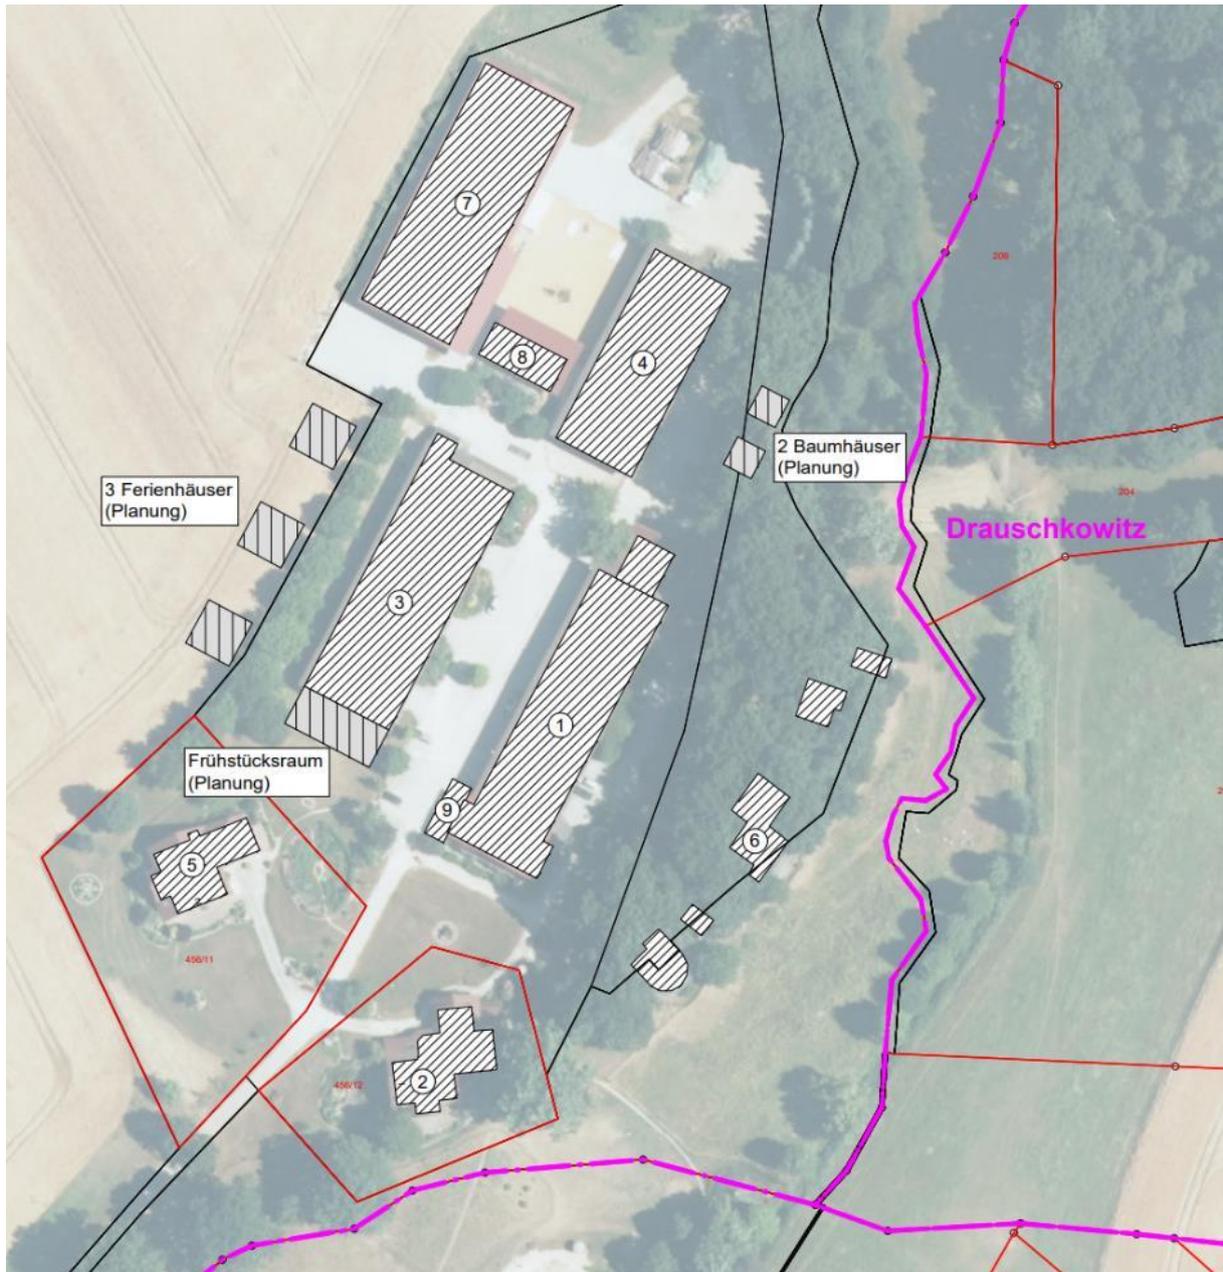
Lage des baulichen Bestandes entsprechend der erteilten Baugenehmigungen (tatsächlichen Nutzungen) sowie Lage der geplanten baulichen Anlagen, Quelle Luftbild: <https://www.geodaten.sachsen.de>
